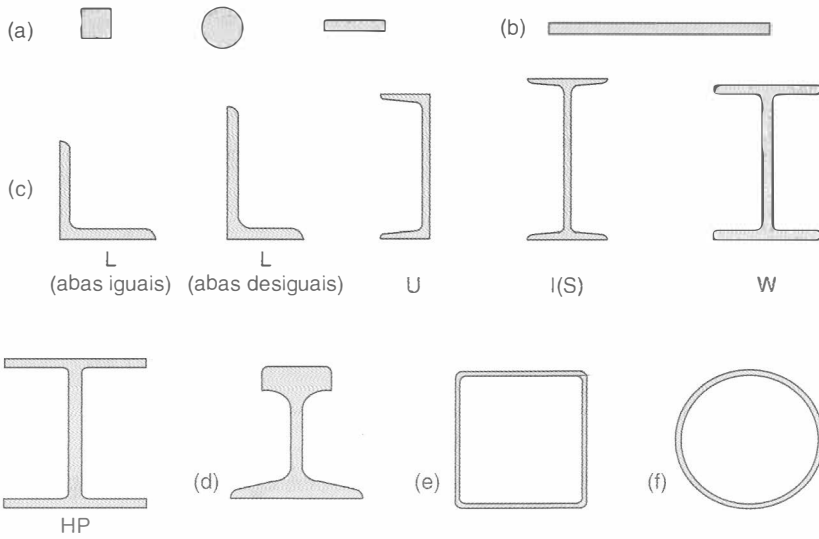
Principais tipos de produtos siderúrgicos laminados de utilização estrutural: (a) barras, com diversas seções transversais (quadrada, redonda, chata); (b) chapas; (c) perfis estruturais laminados; (d) trilho; (e) tubo quadrado; (f) tubo redondo.
